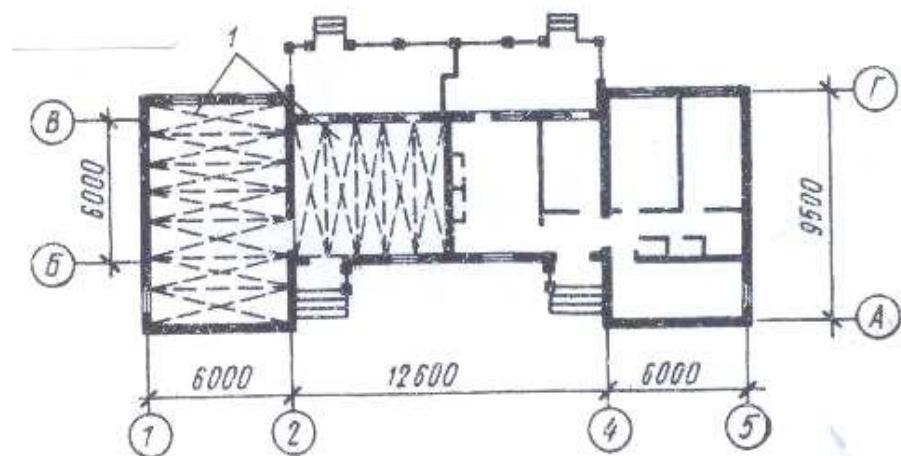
Конструктивные схемы с перекрестным расположением несущих стен
